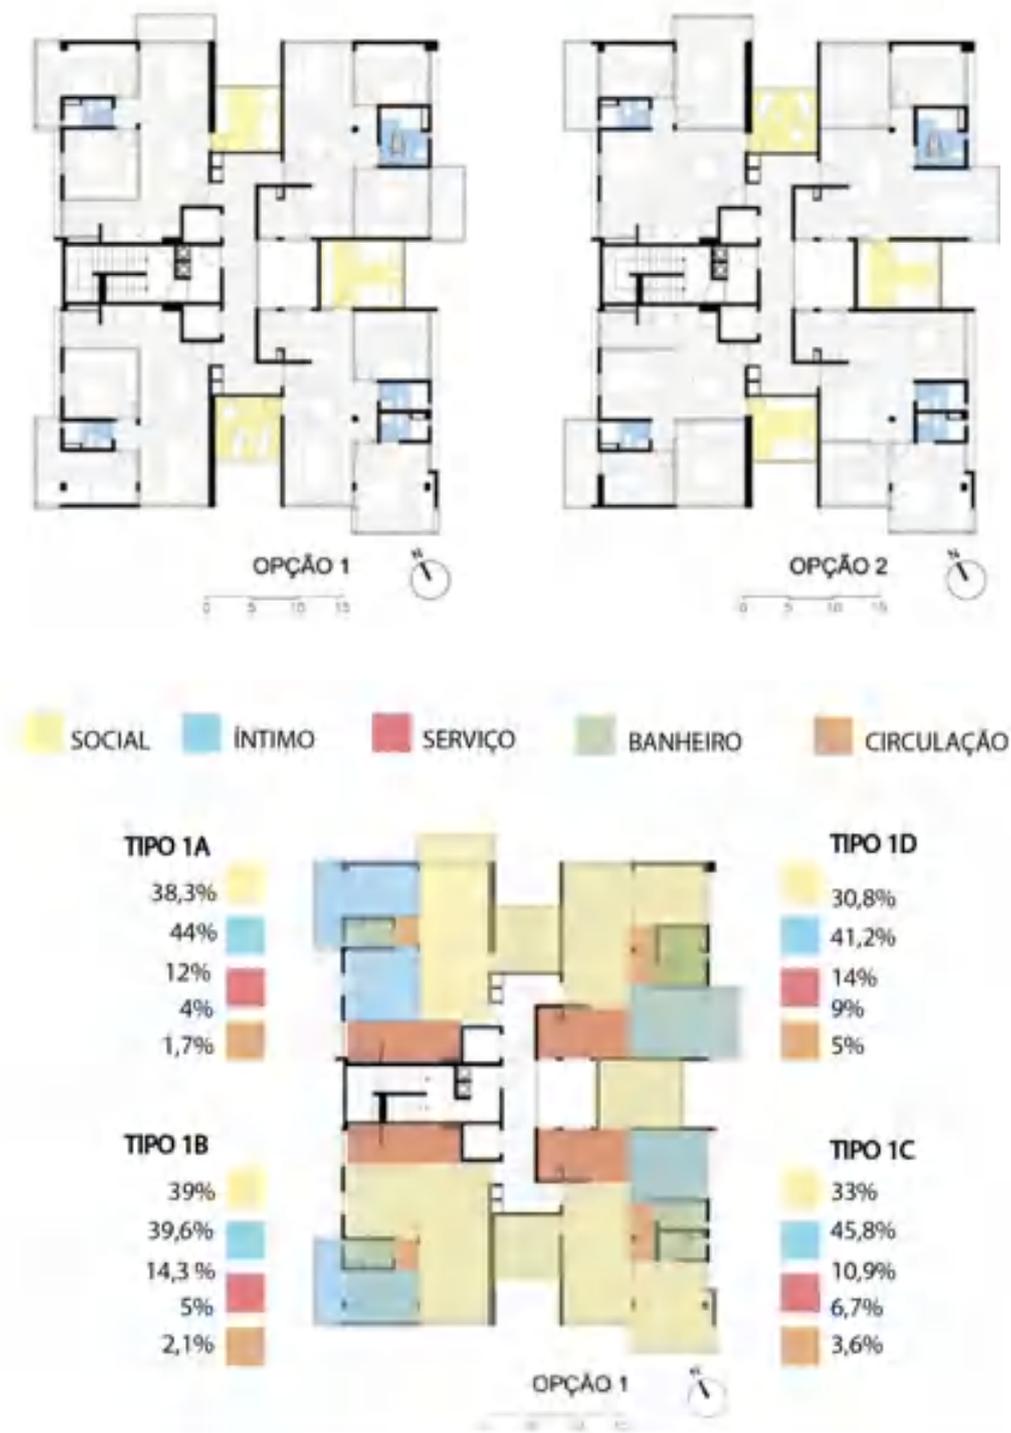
Opções de planta baixa dos apartamentos e suas ampliações e zoneamento das unidades habitacionais. Fonte: Vila Nova Arquitetura, esquematizado pelo autor
